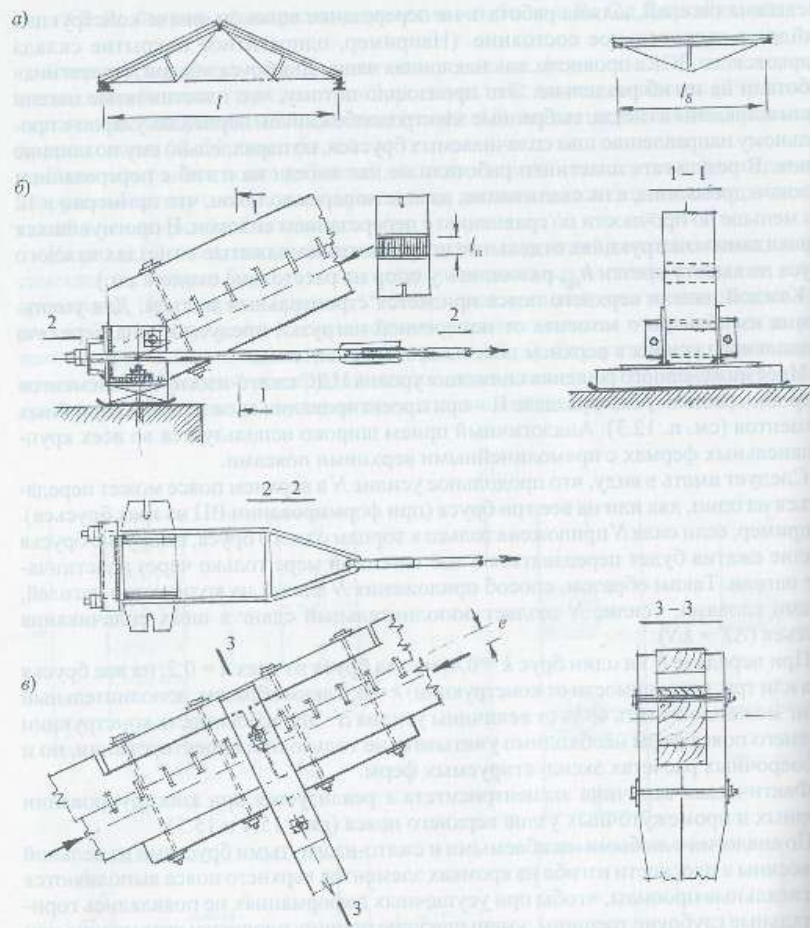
Фермы с верхним поясом из двух брусьев и узлы с центровкой усилий: а – схемы конструкций; б – опорный узел; в – промежуточный узел фермы
